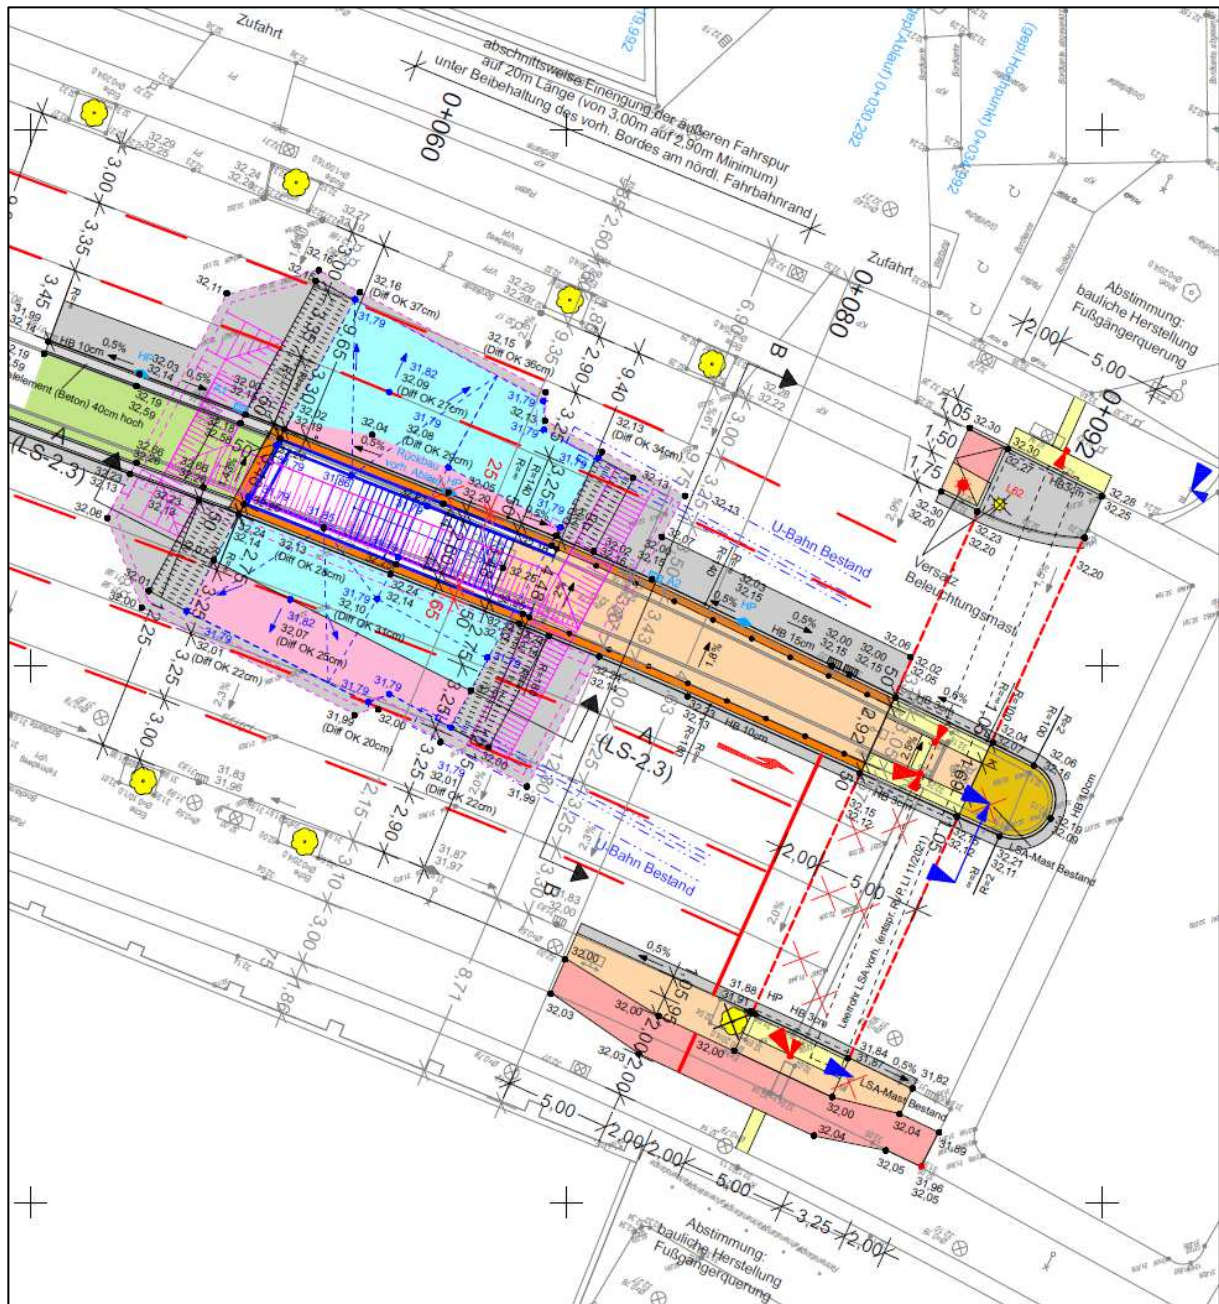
Ausschnitt Plan EIBS Zi\_VA\_EP 5.1 Lageplan (unmaßstäblich)
